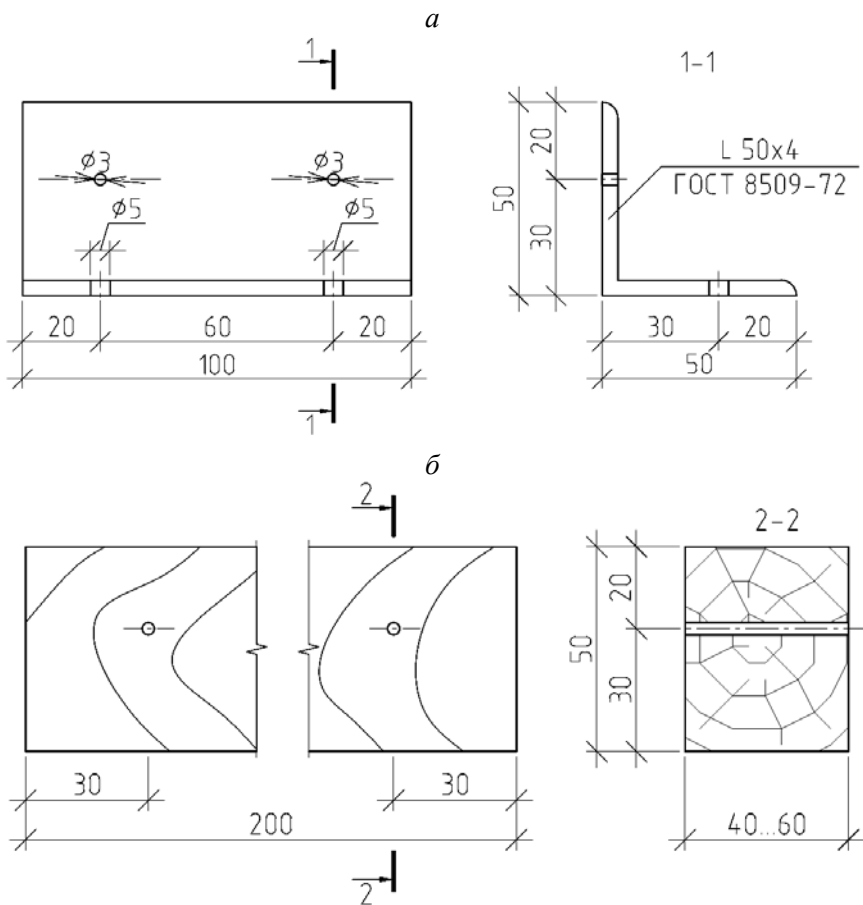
Элементы крепления гипсовых пазогребневых плит к конструкциям здания:
